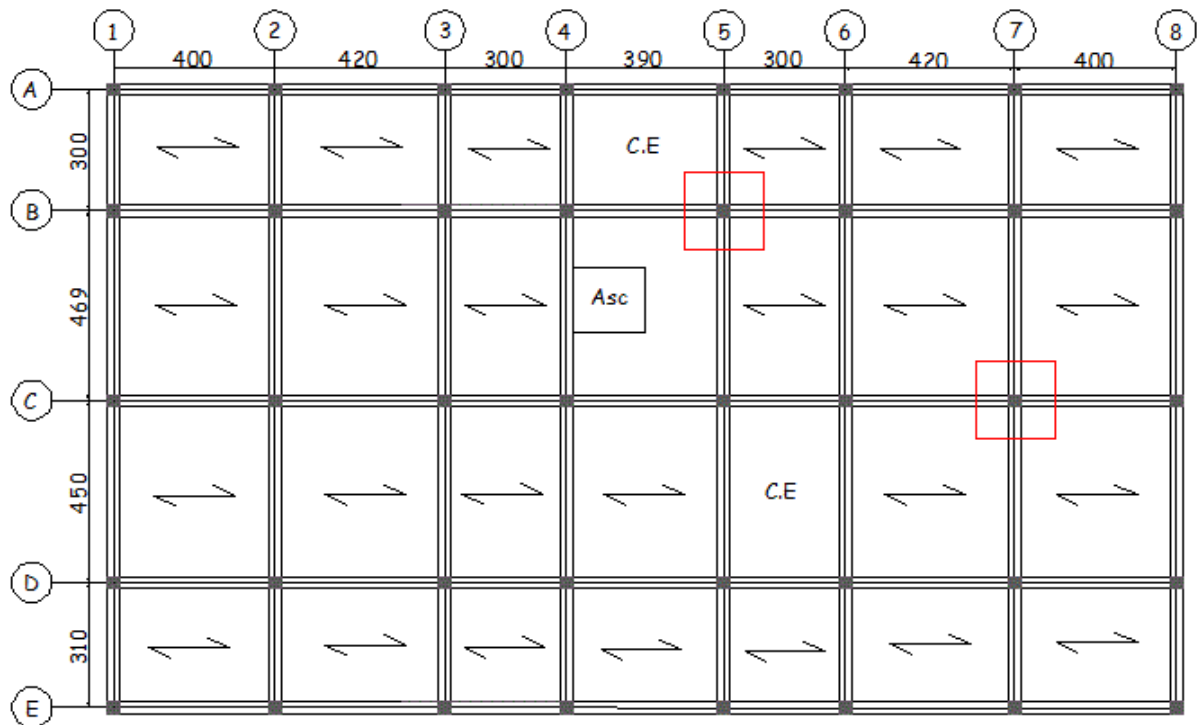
Schémas de la disposition des poutrelles dans étage service.
